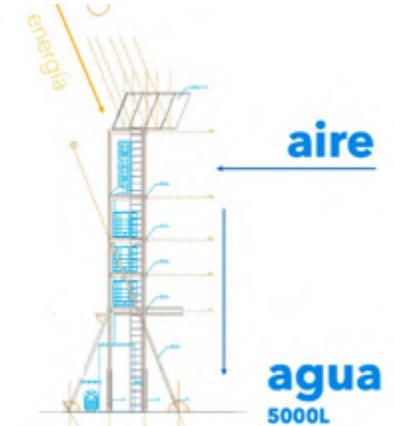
Planimetría Proyecto Despegar 2020 (Archivo digital Arquitectura USACH)
